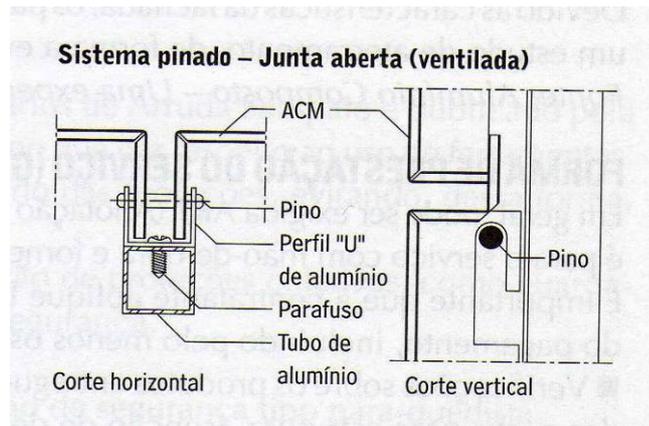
Sistema pinado – Junta aberta (ventilada)
